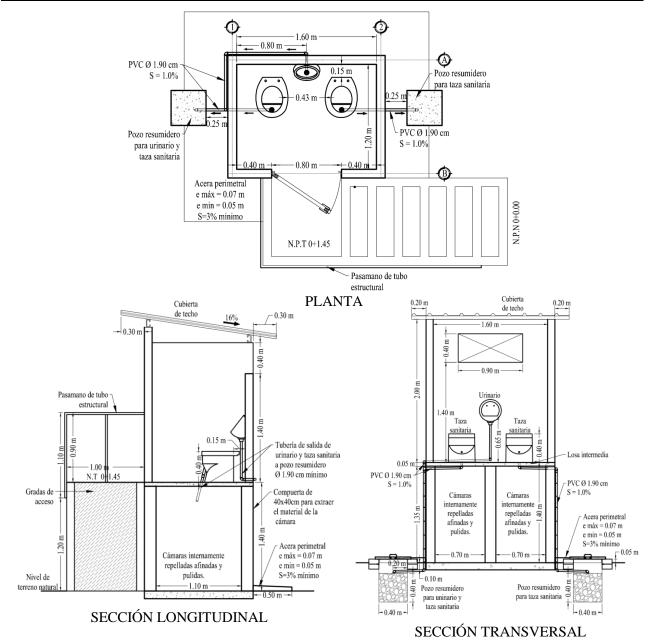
Vista en planta y elevación de los detalles constructivos de letrina de doble cámara elevada
